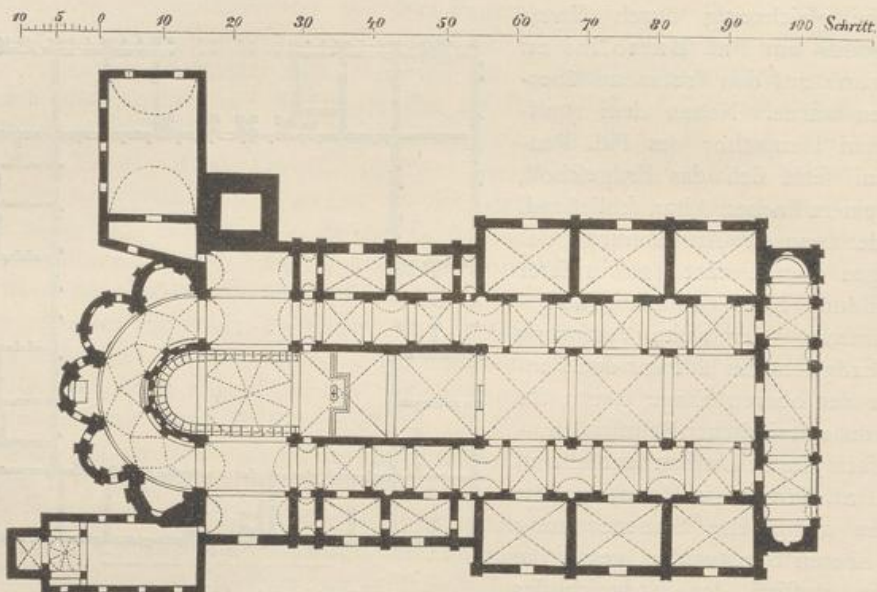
Grundriß der Kirche in S. Benedetto. (M. Lohde.)
